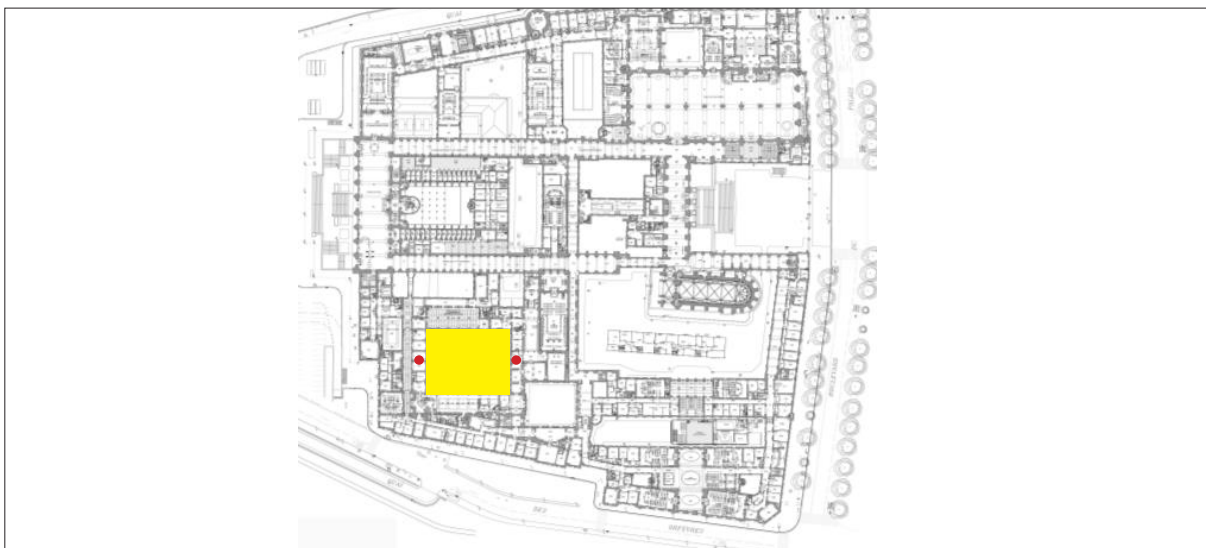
plan de localisation de la zone concernée par les travaux (en jaune : l'emprise ; en rouge : les reconnaissances de fondation)
